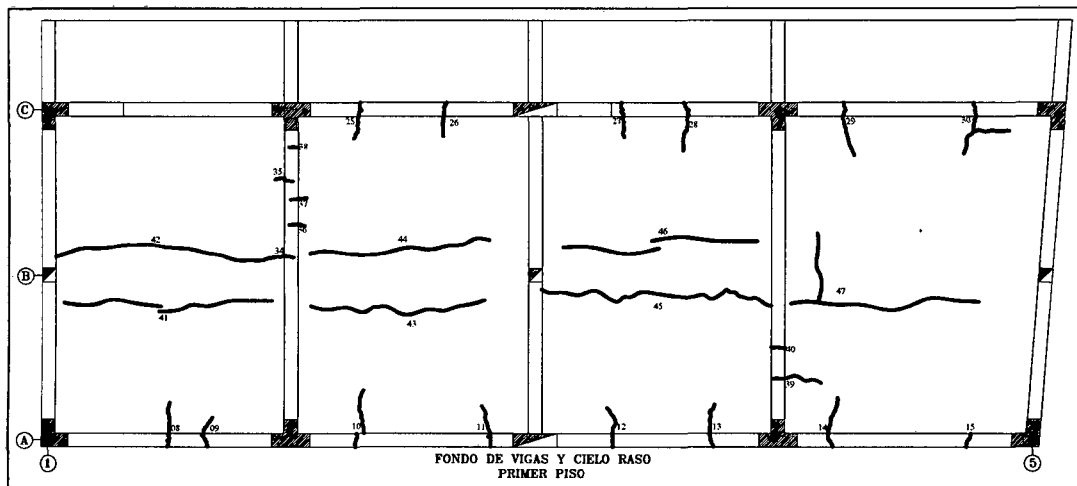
Lesiones existentes en losa (cielo raso y fondo de vigas primer piso)
